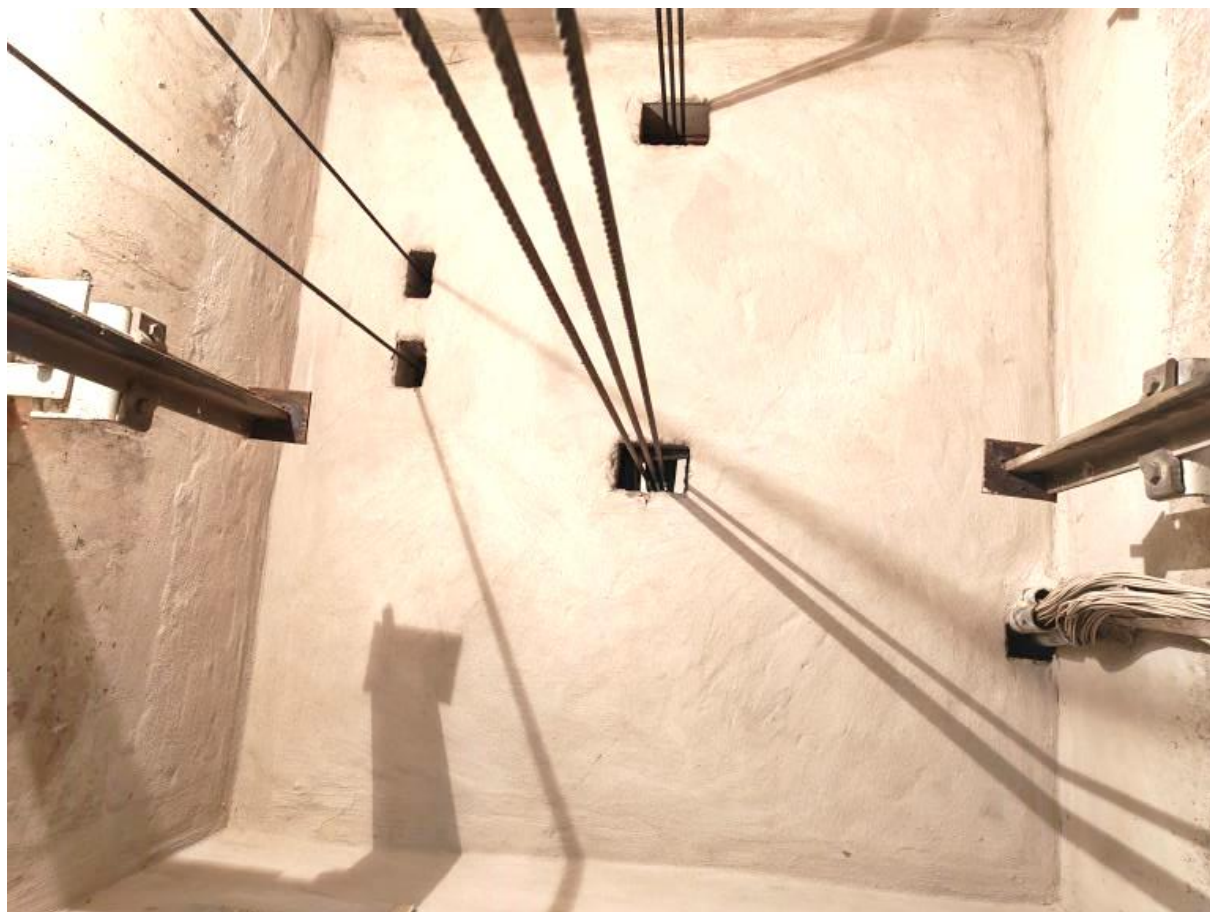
Вид на плиту перекрытия шахты лифта Л4.
